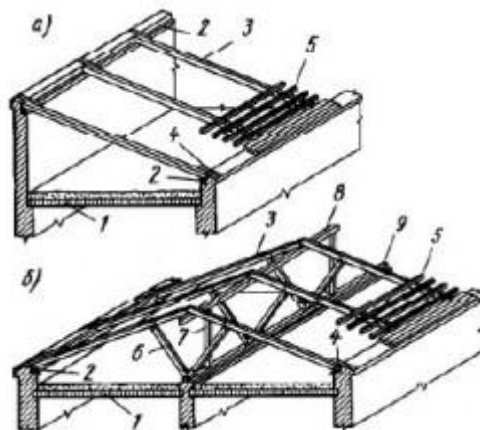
Крыши из наслонных стропил: 1 — чердачное перекрытие, 2 — мауэрлат, 3 — стропильная нога, 4 — кобылка, 5 — обрешетка, 6 — подкос, 7 — стойка, 8 — прогон, 9 — лежень
